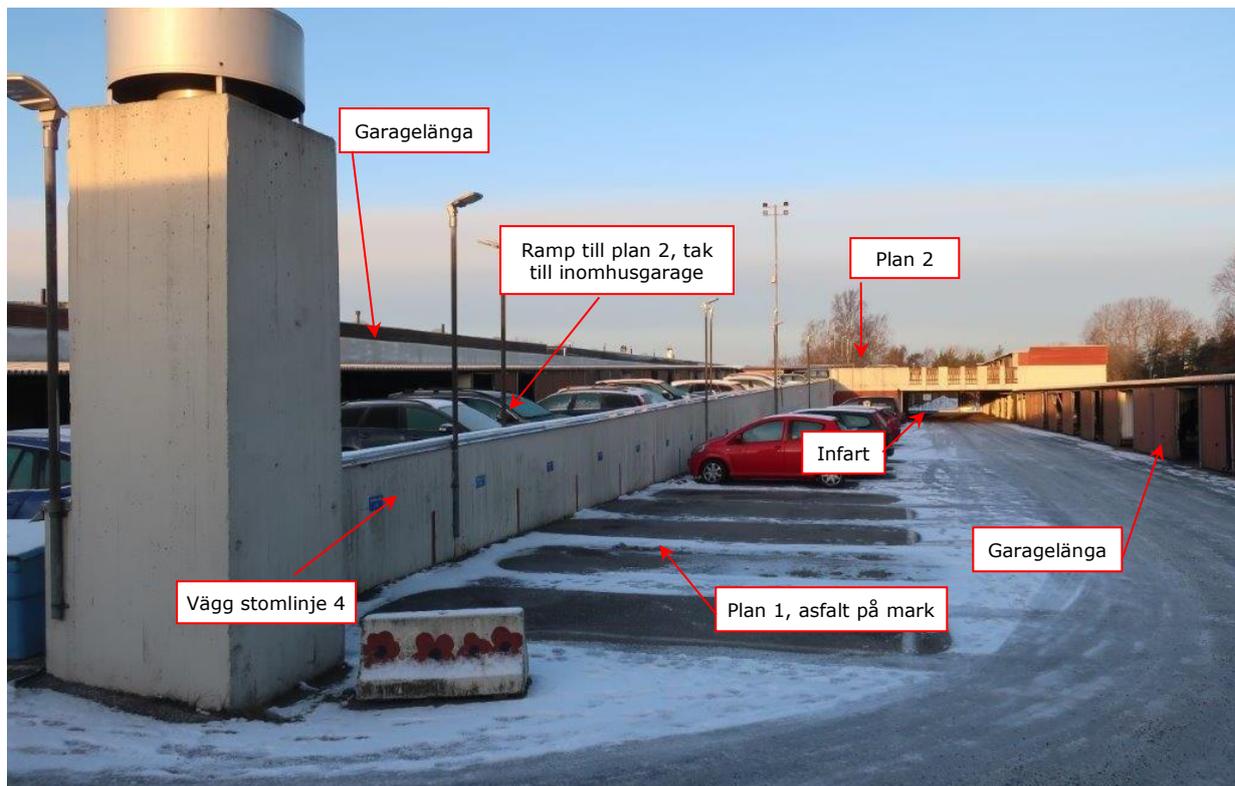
Garagelängor utmed långsidorna på plan 1 och plan 2.
